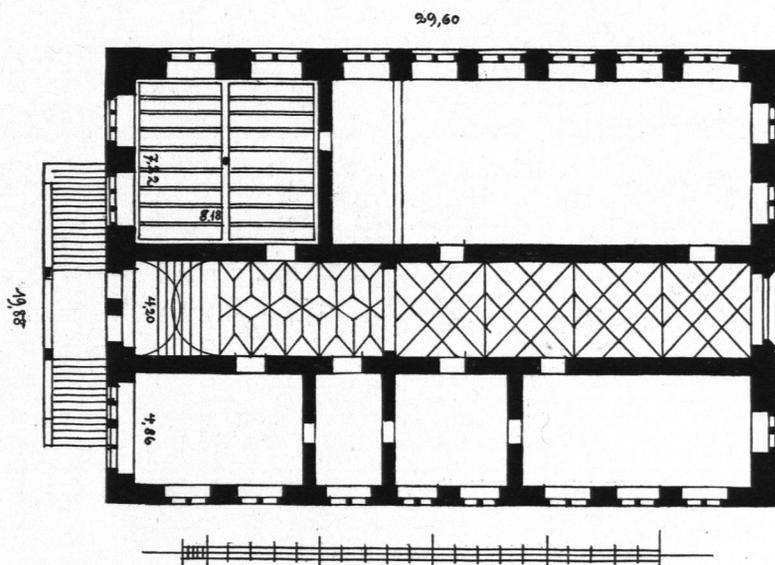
Rathaus zu Mauen. Grundriß des Erdgeschößes.
